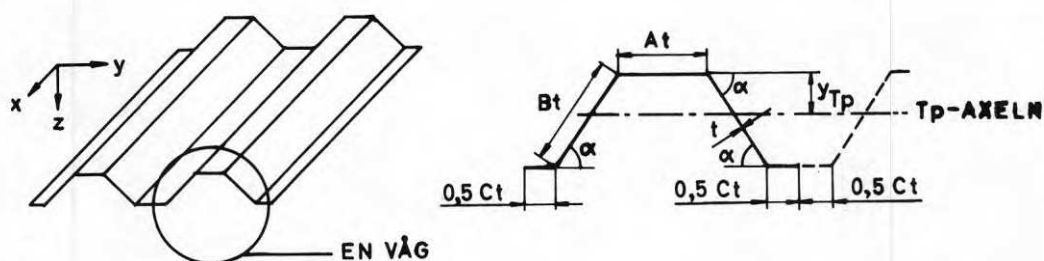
Trapetsprofilerad plåt. Balktvärsnitt
